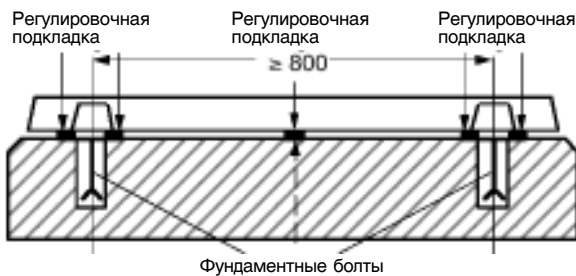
Расположение регулировочных подкладок под опорной плитой
